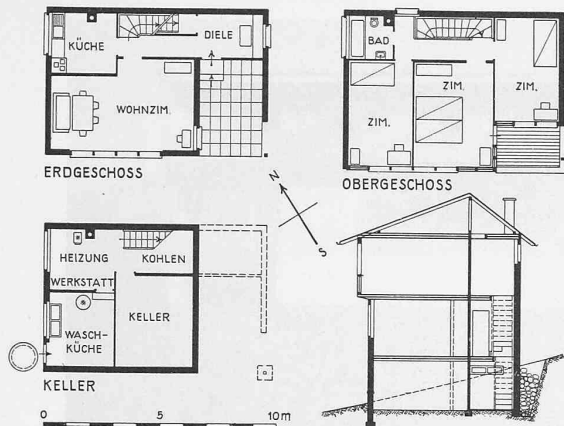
und 16. Grundrisse 1 : 300 und Ansicht des Hauses in Erlenbach.
